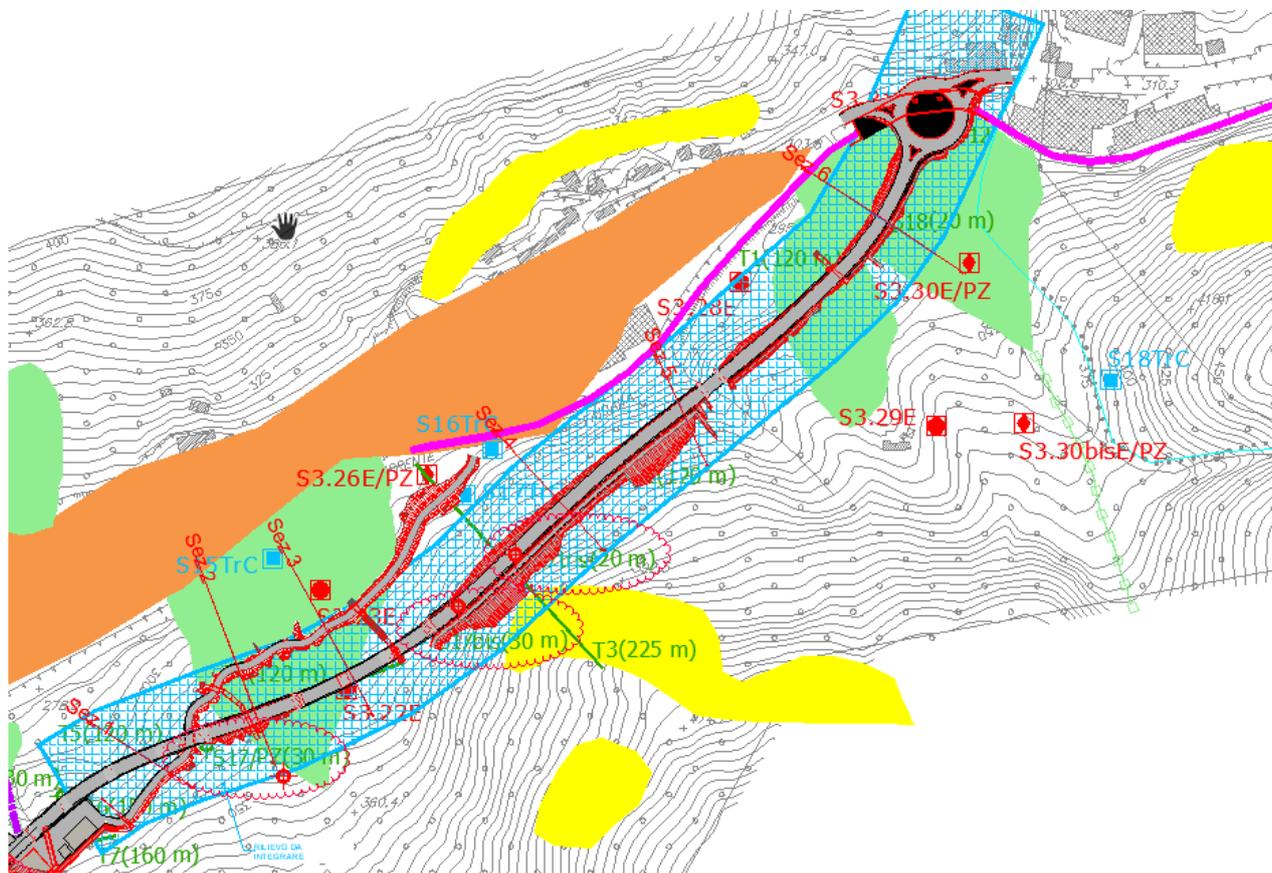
Planimetria con indicazione dei movimenti franosi
